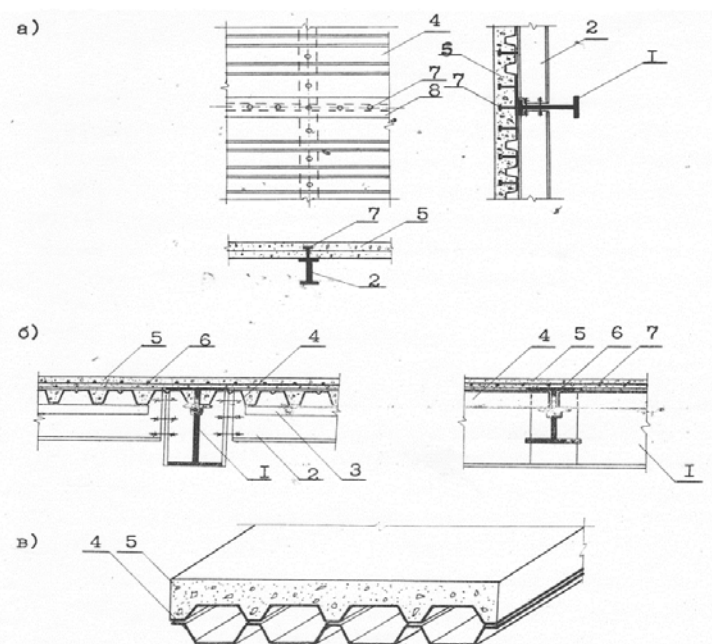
Конструкция перекрытий, применяемых в Чехии и Польше а – система «VIP»; б – перекрытие экспериментального здания (г. Садкс); в – перекрытие здания «Metalplast» (г. Познань); 1 – главная балка; 2 – второстепенная балка; 3 – полка из уголков; 4 – настил; 5 – бетон; 6 – продольные стержни; 7 – поперечные стержни; 8 – вставной лист.
